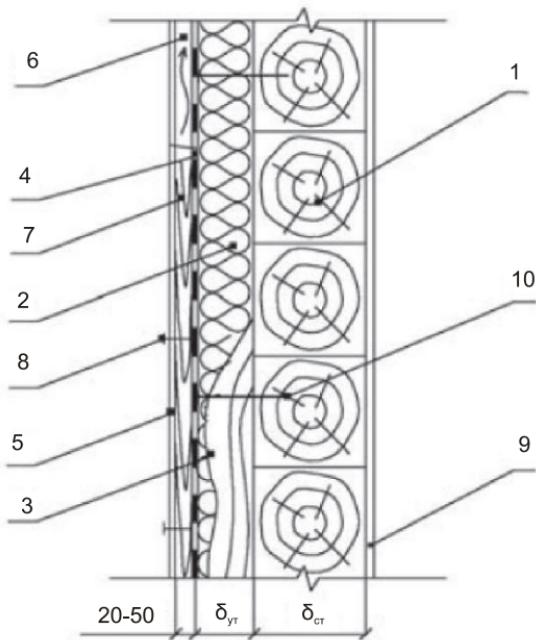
Утепление стены из бруса плитами ИЗОРОК в конструкции с вентилируемым зазором и облицовкой листовым или плитным материалом: 1 — стена из бруса; 2 — плиты ИЗОВЕНТ¹; 3 — вертикальная стойка из бруса; 4 — супердиффузионная мембрана ISOROC FOIL HI²; 5 — облицовка; 6 — вентилируемый зазор; 7 — вертикальная деревянная планка; 8 — крепежный элемент (винт, шуруп и т. п.); 9 — внутренняя облицовка (гипсокартон, вагонка и т. д.); 10 — дюбель или гвоздь с шайбой
